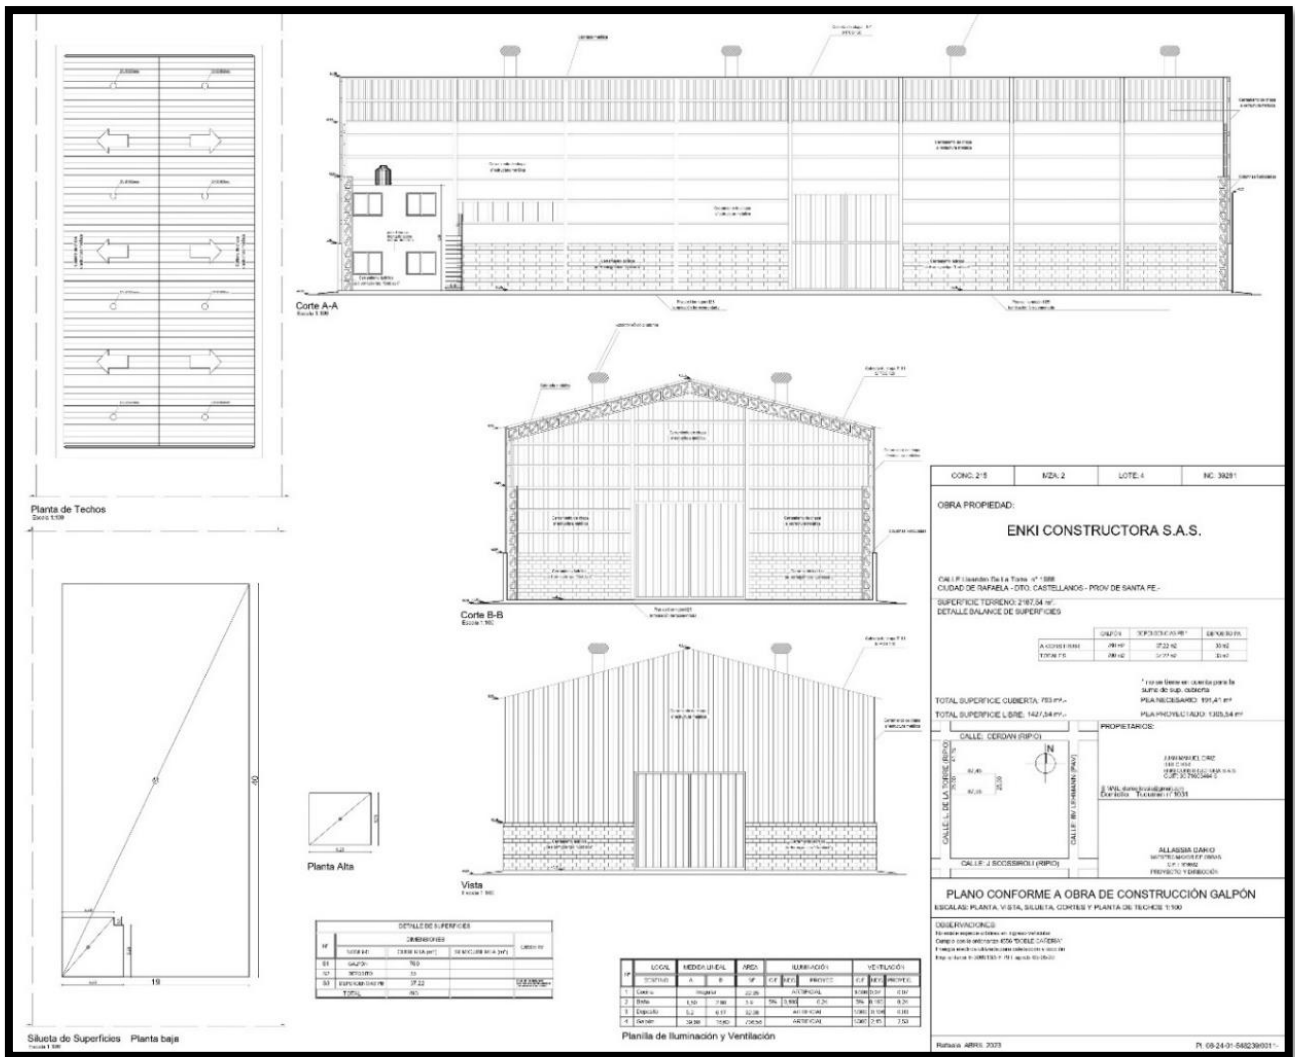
Fachadas del taller donde se producen elementos metálicos.
